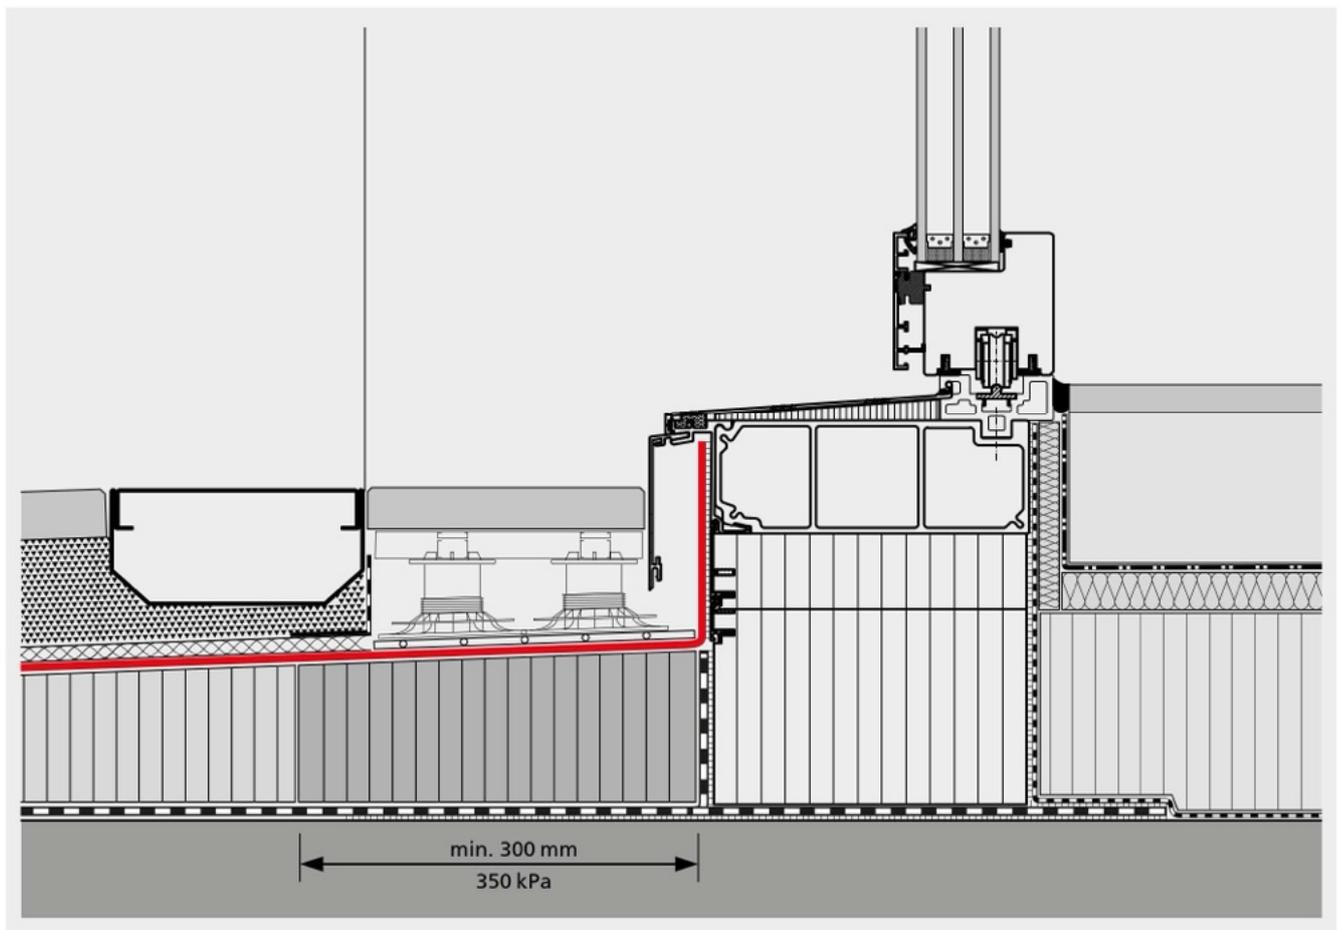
Caniveau sur couche d'usure à joints fermés sur la ligne de fuite de la façade avec zone de couverture à joints ouverts près de la fenêtre.
